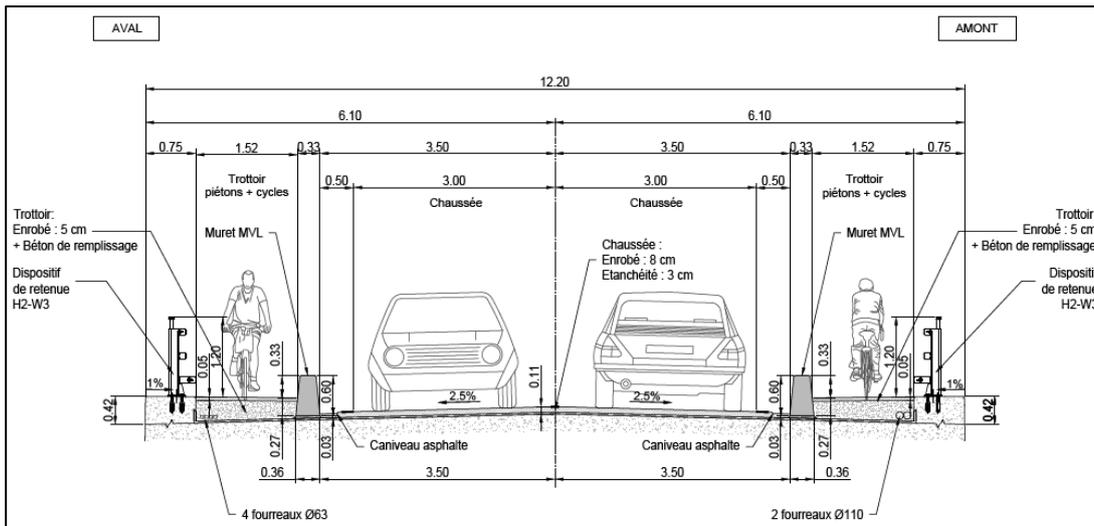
Coupe transversale fonctionnelle sur l'ouvrage d'art (Source : Arcadis)
